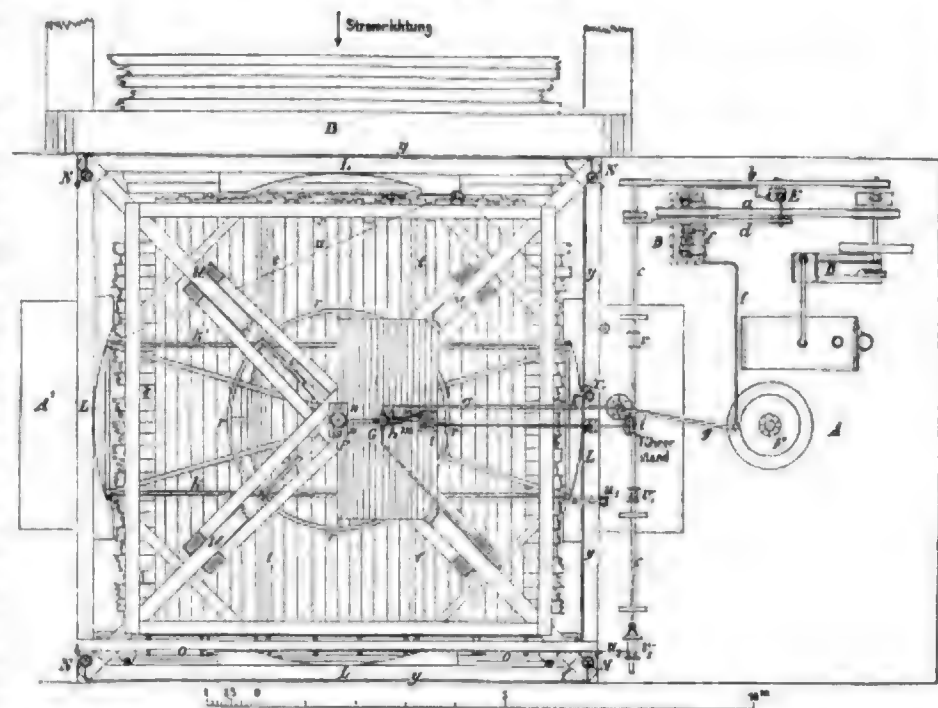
Grundriss und Aufsicht von oben.
